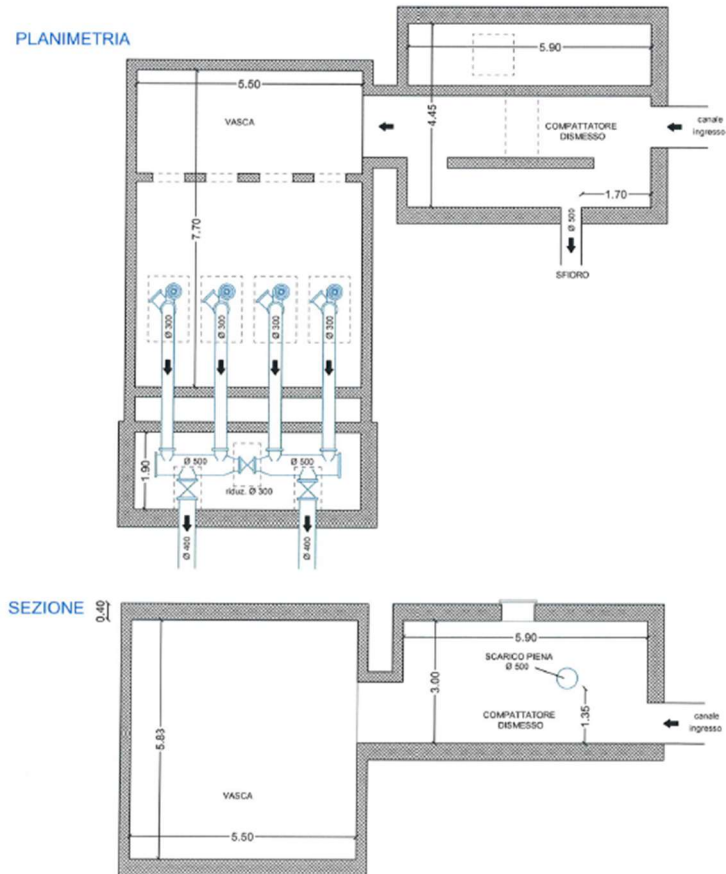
Pianta e sezione di uno scolmatore su sollevamento con vasche separate (VASCA00132)
